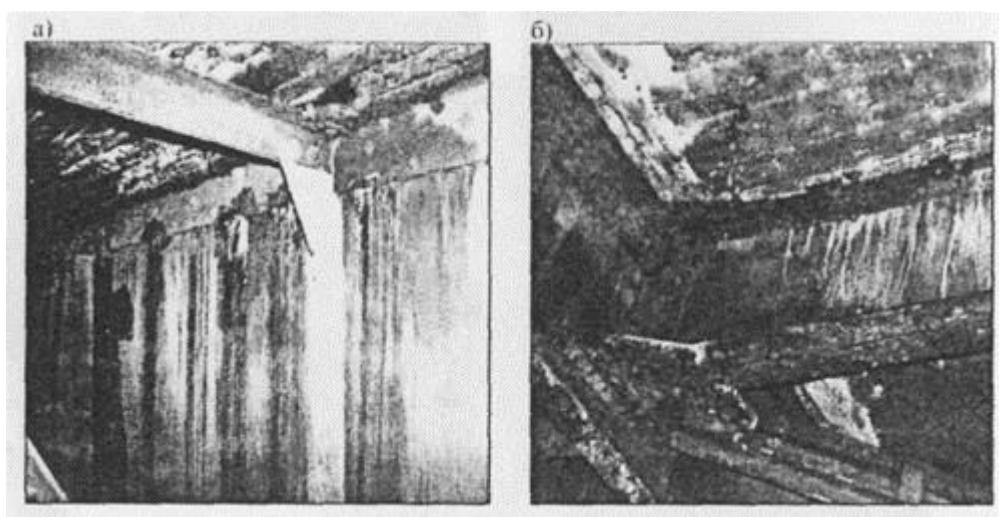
Коррозионные повреждения металлоконструкций пролетных строений с железобетонной плитой проезжей части при нарушениях гидроизоляции и протечках через плинтус
